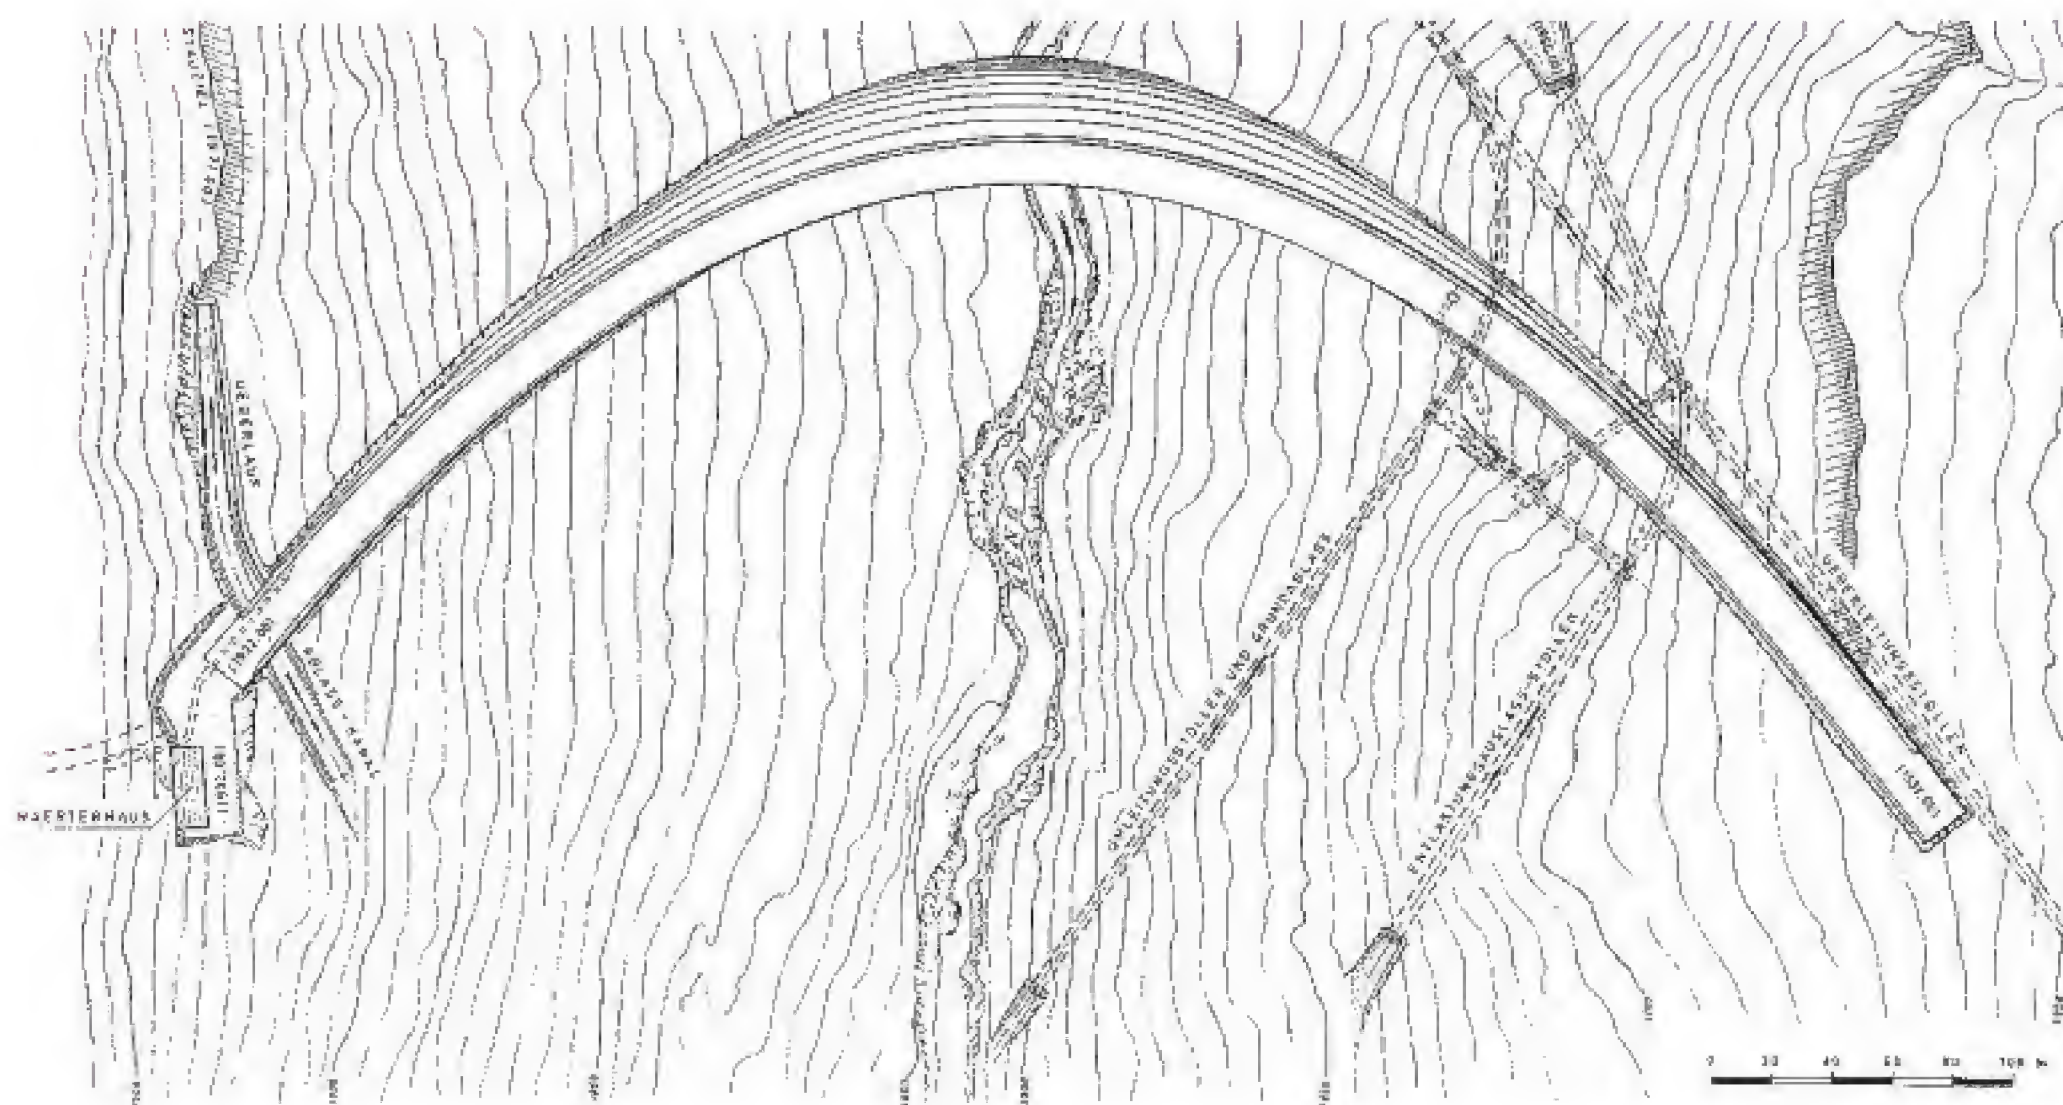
Exemple d'implantation d'un barrage-voûte (barrage de Zervreilla).
